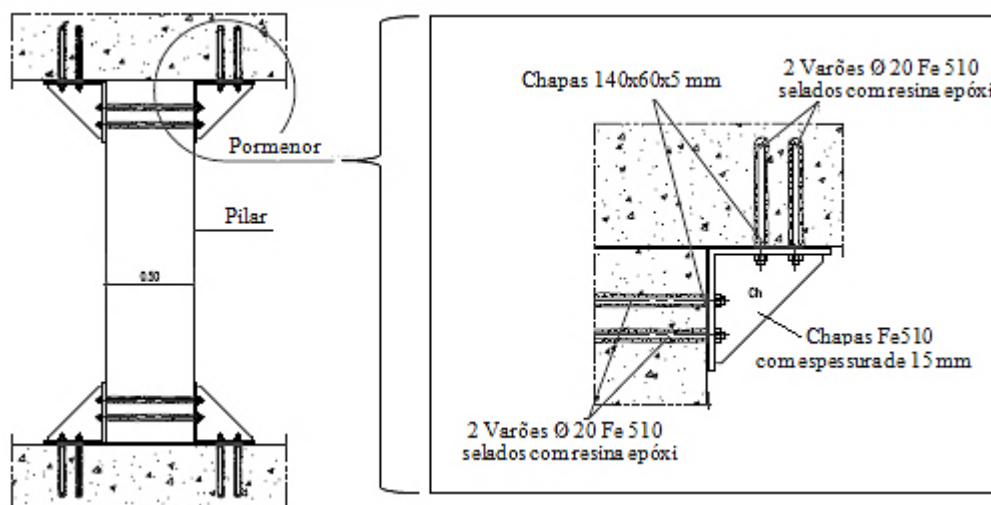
Pormenor do reforço de um dos pilares do encontro Sul (adaptado de Brisa, 2002b).
